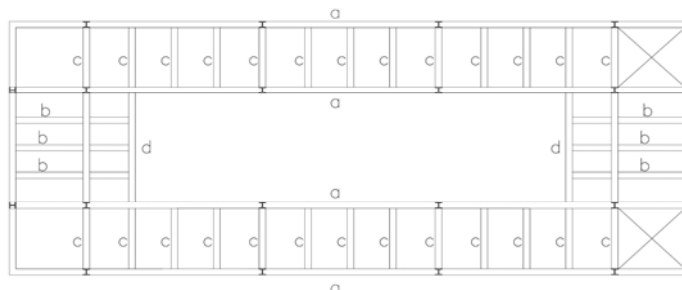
Lançamento de vigas e pilares da estrutura independente.
